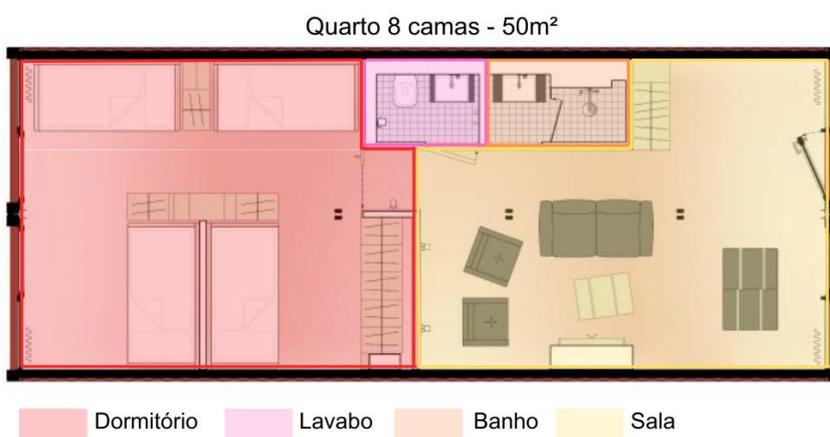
Setorização / Planta baixa quarto compartilhado. Alterado pelo autor
